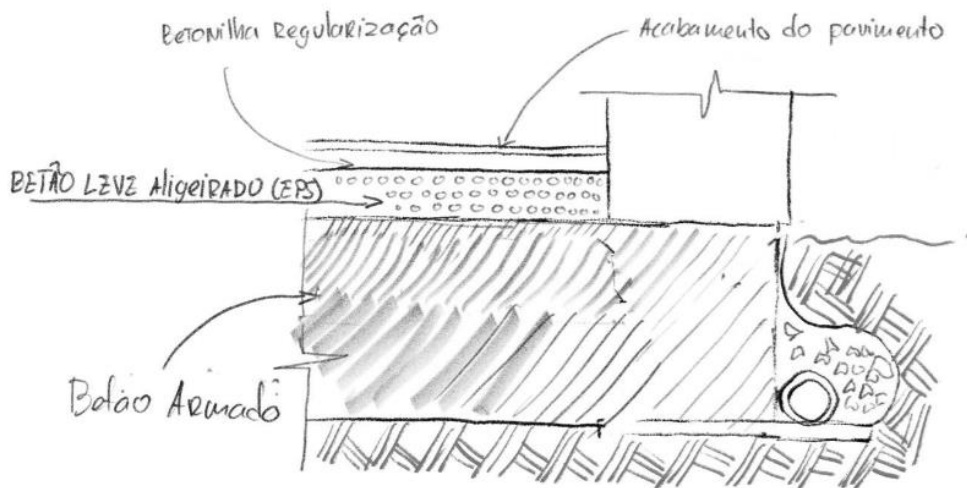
Pormenor construtivo do pavimento em contacto com a terra
